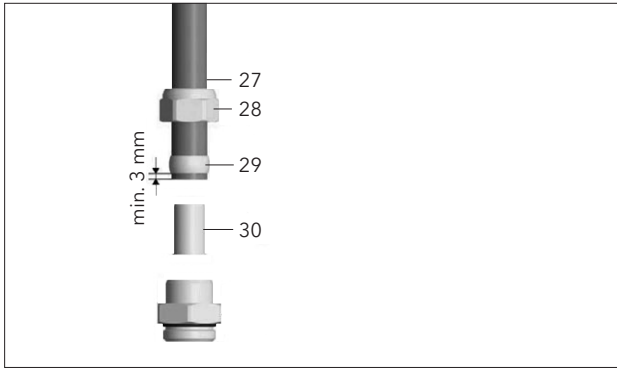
Klemmringverschraubung an den Anschlüssen: 27 Rohrstützen; 28 Überwurfmutter; 29 Klemmring; 30 Stützhülse
